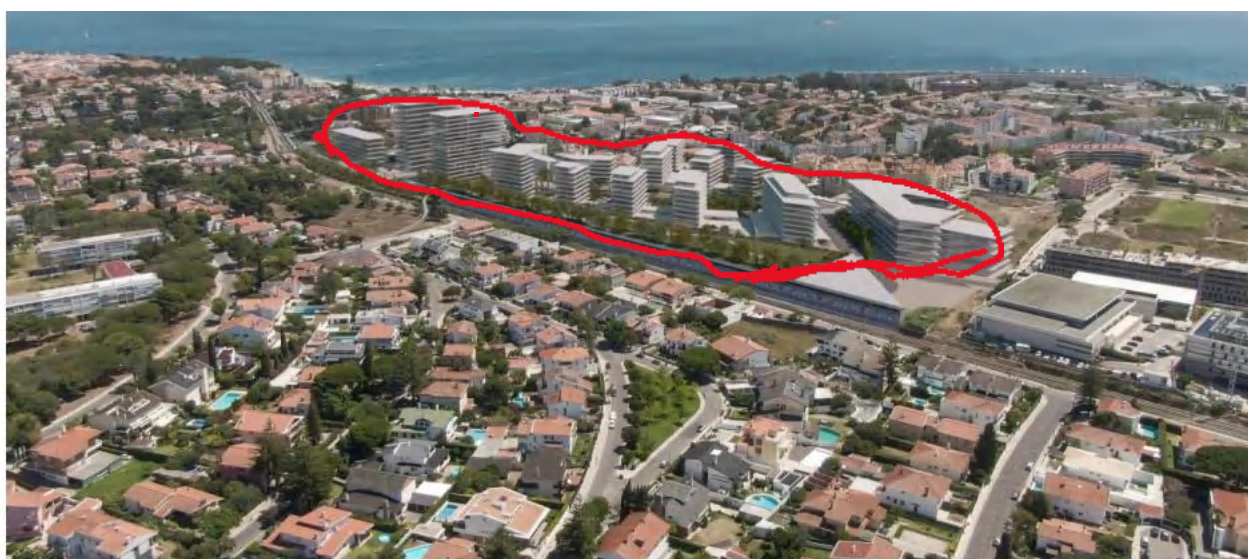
Imagem retirada do projeto onde se assinalou a zona de intervenção
